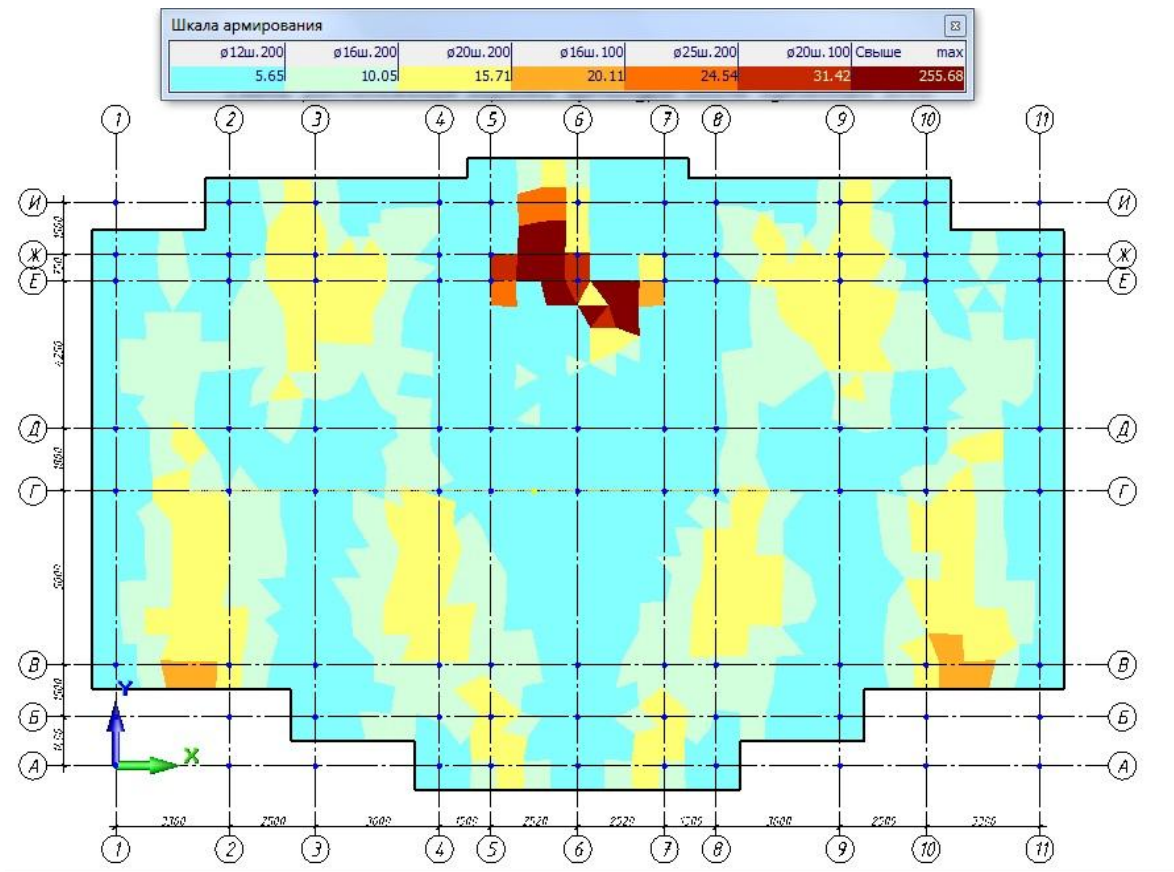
Армування верхньої зони фундаментної плити по осі Y
